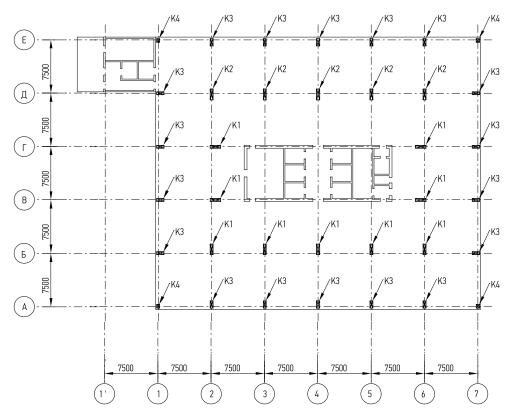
Монолитный железобетонный каркас с безбалочной системой перекрытия при сетке 7,5х7,5 м.
